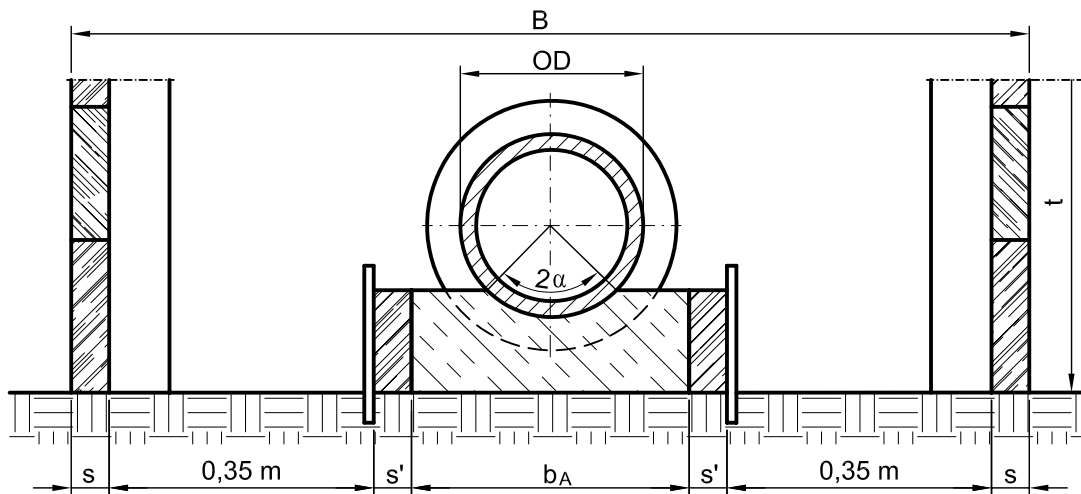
Graben für Abwasserkanäle auf Betonbettung
